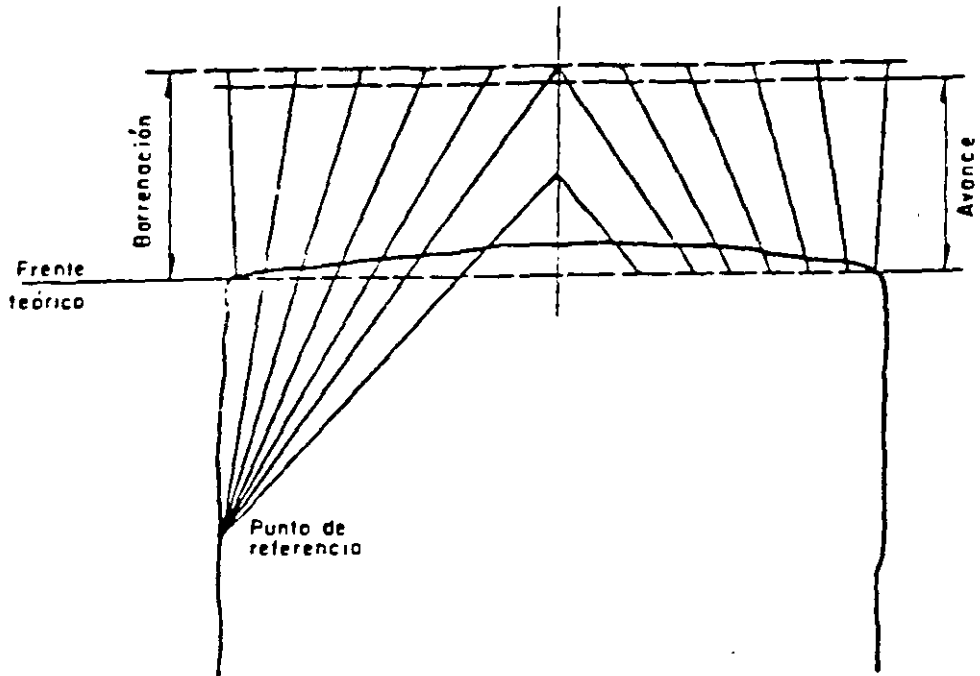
Distribución en planta de los barrenos de la cuña y los de fuera de la cuña
